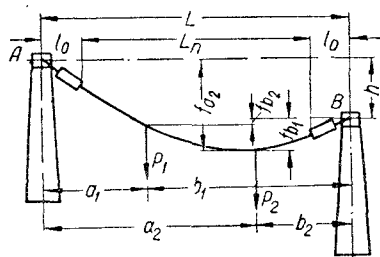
К расчету проводов (гибких шин) с точками подвеса на разных высотах и с грузами, расположенными в любых двух точках пролета.
